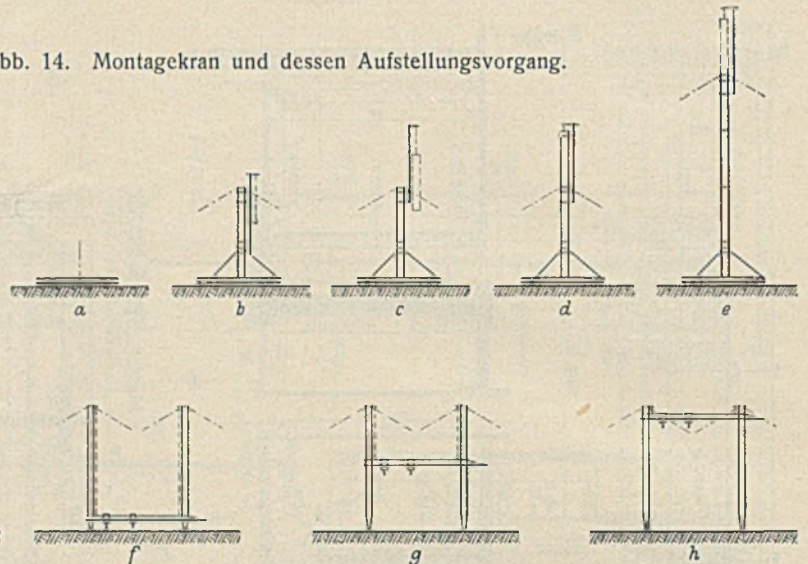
Montagekran und dessen Aufstellungsvorgang.
